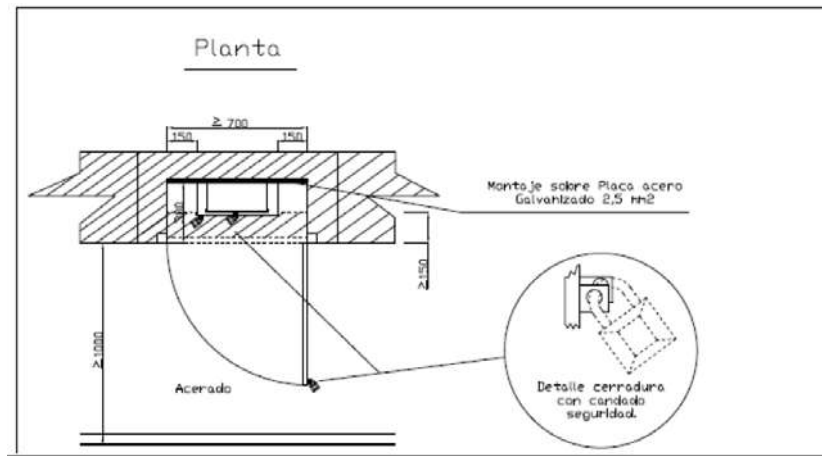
Instalación CGP y CS montaje vertical. Planta.
